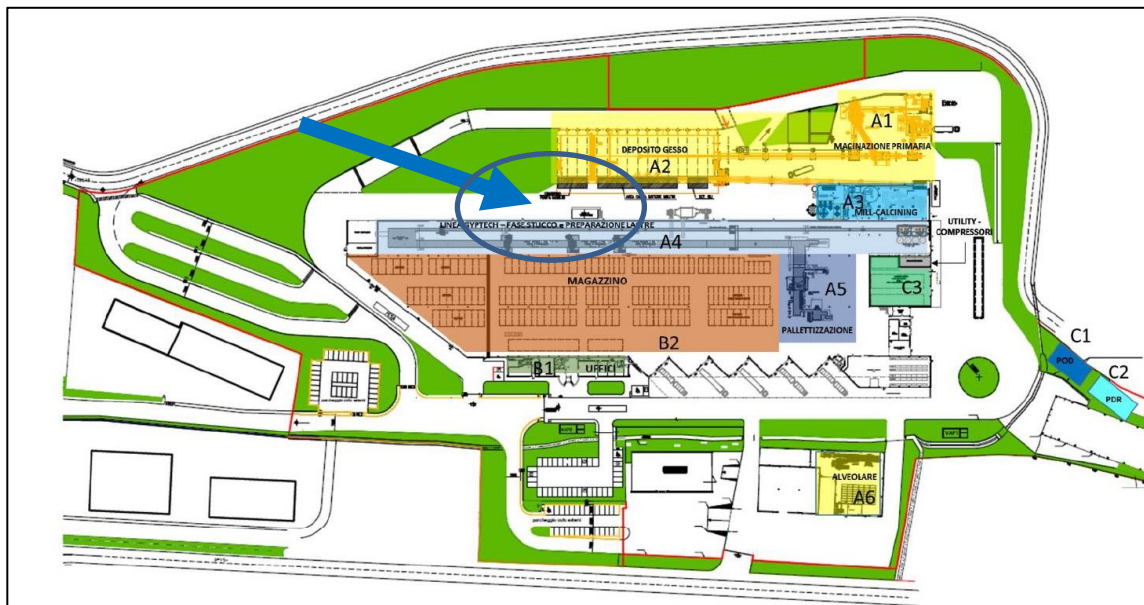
Indicazione in planimetria dell'area di posizionamento del cogeneratore
